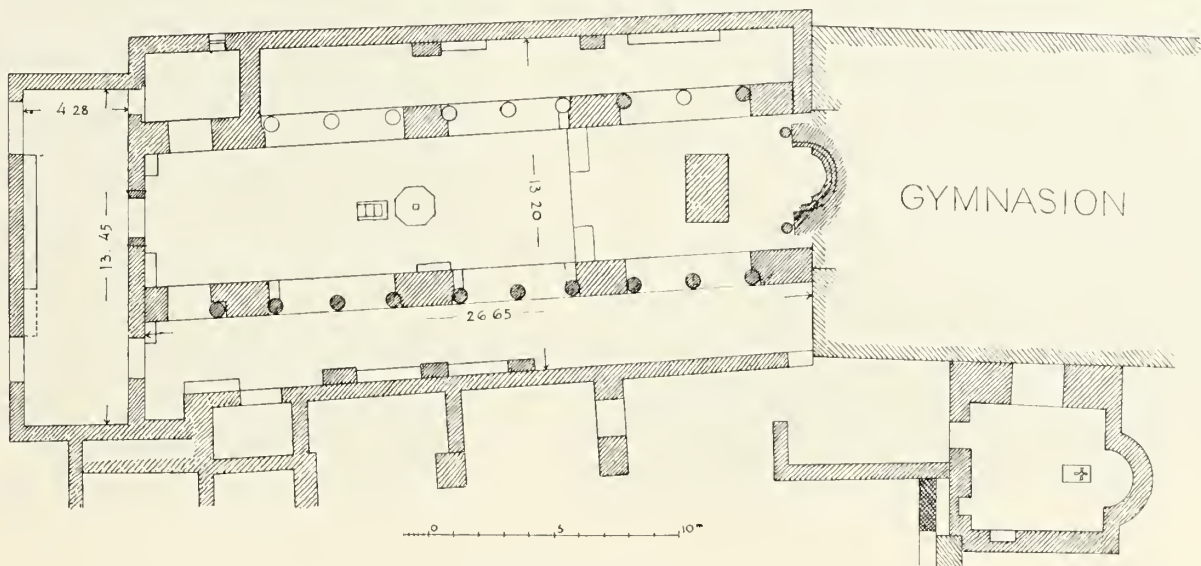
Grundriss der grossen Kirche beim Theater.
